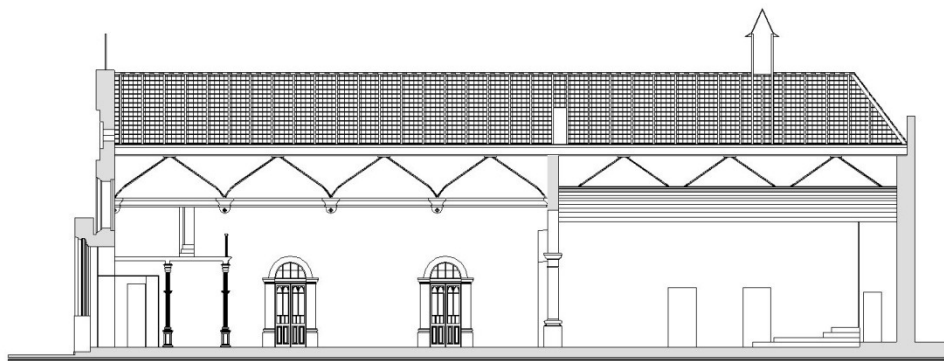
e: Igreja da Ordem III de São Francisco das Chagas – croqui: corte longitudinal nave e presbitério.
